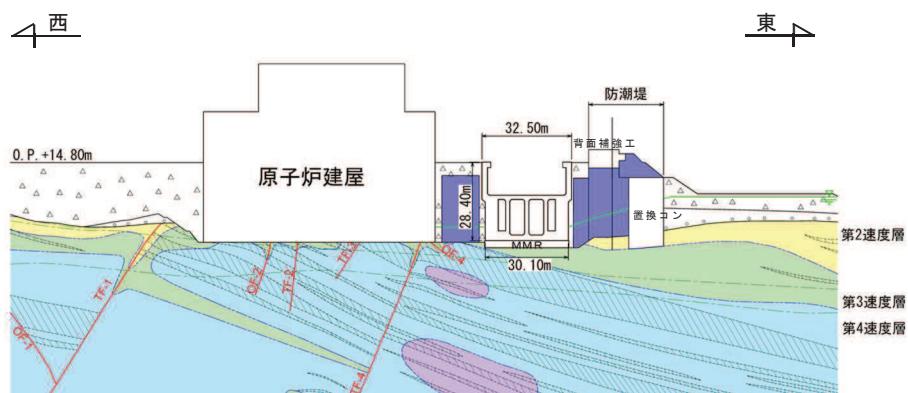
海水ポンプ室地質断面図 (B-B)
